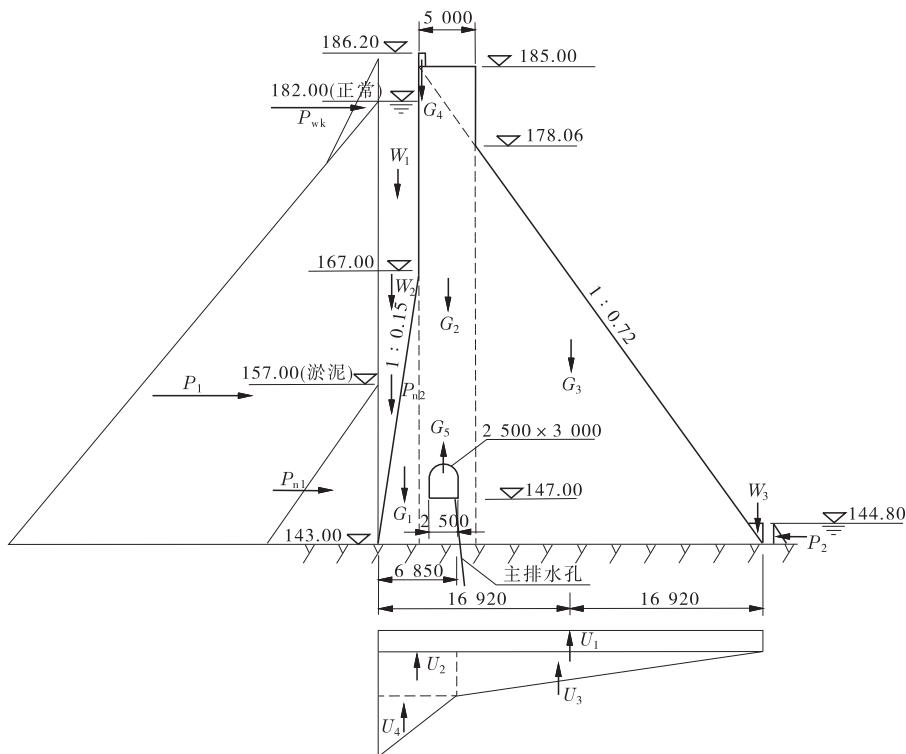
正常蓄水位情况下非溢流坝的荷载计算简图 (尺寸单位: mm; 高程单位: m)
